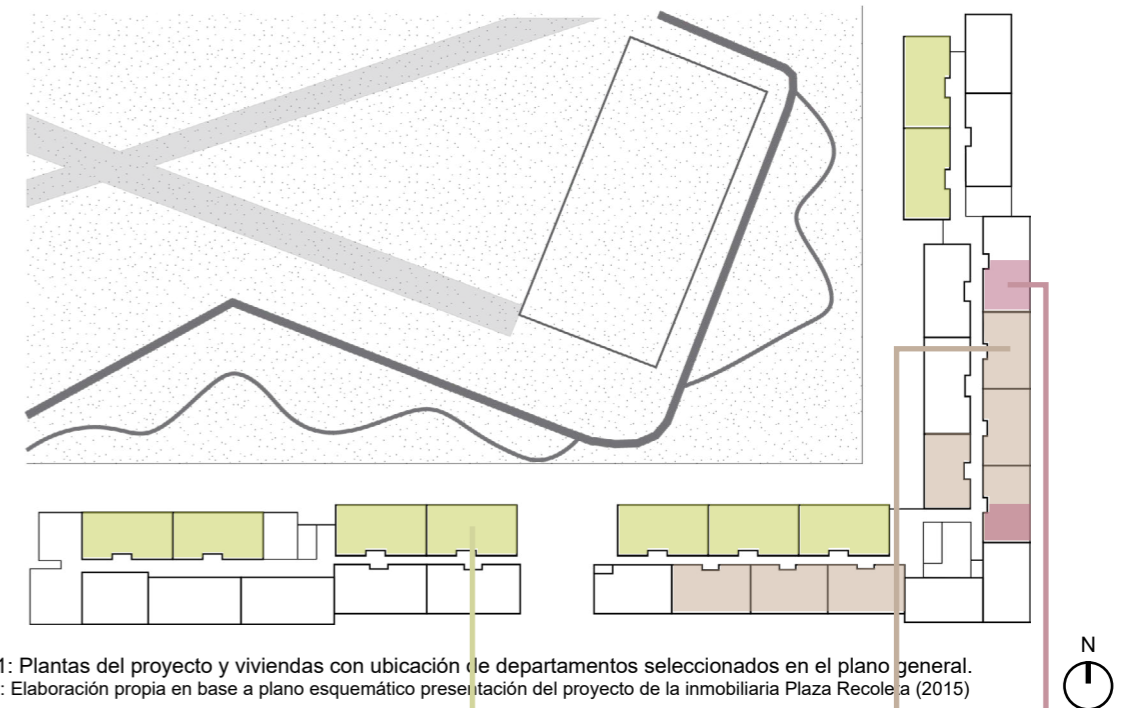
Plantas del proyecto y viviendas con ubicación de departamentos seleccionados en el plano general.
